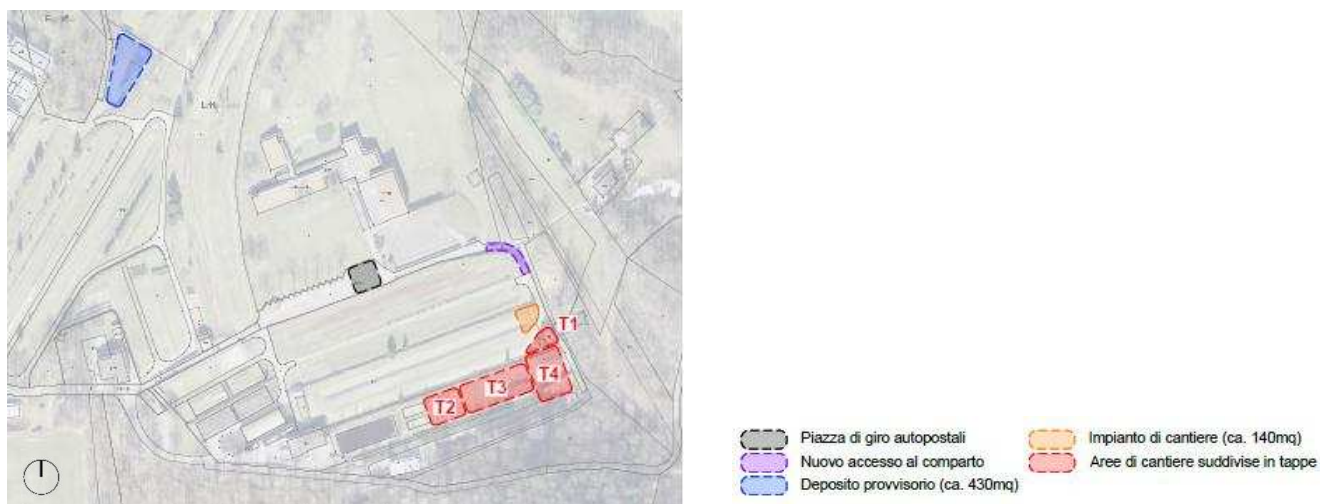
Planimetria generale raffigurante l'area di cantiere
